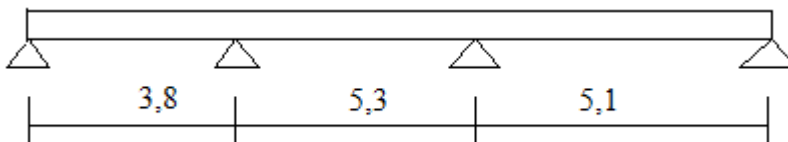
Schéma statique de poutrelle type 4 (étage)
